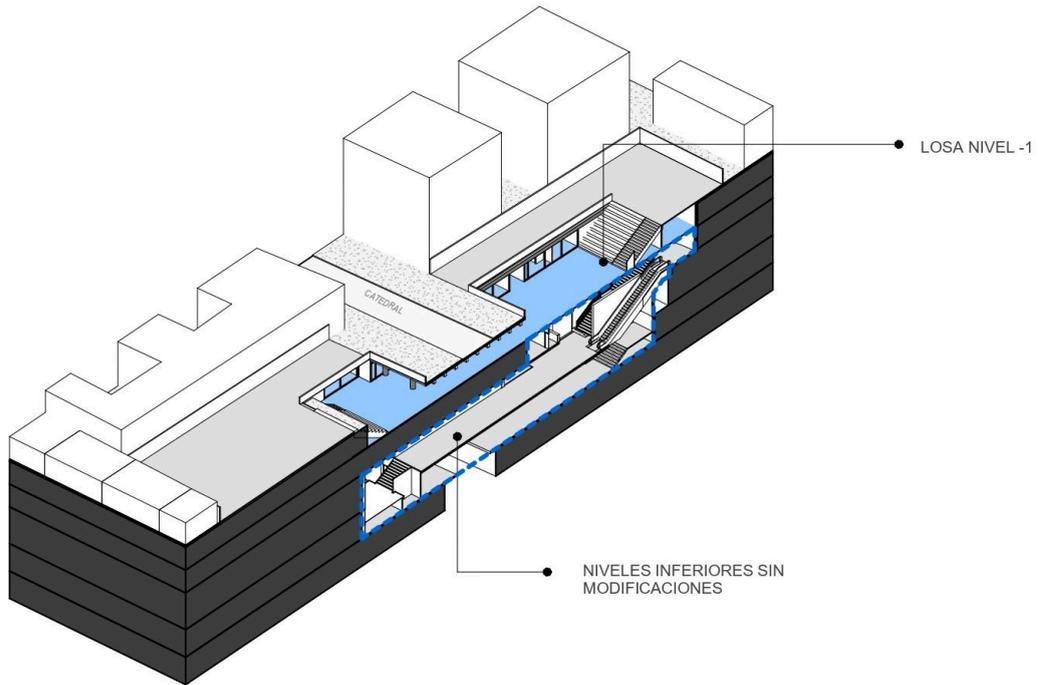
Esquema de conexión subterránea entre terrenos corte. Fuente: Elaboración propia.
